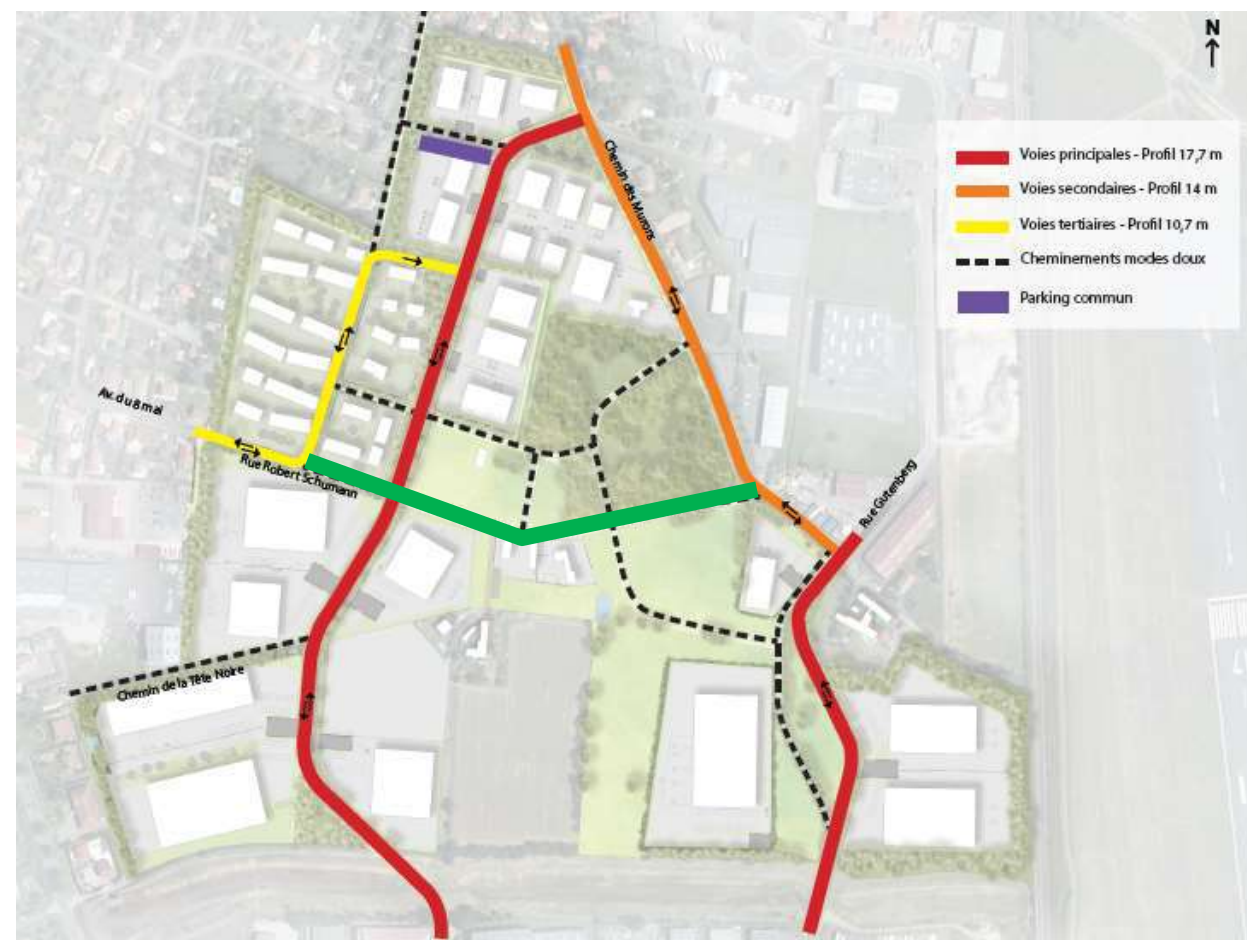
Future plan de voirie (Lieux Fauves, 2023)
